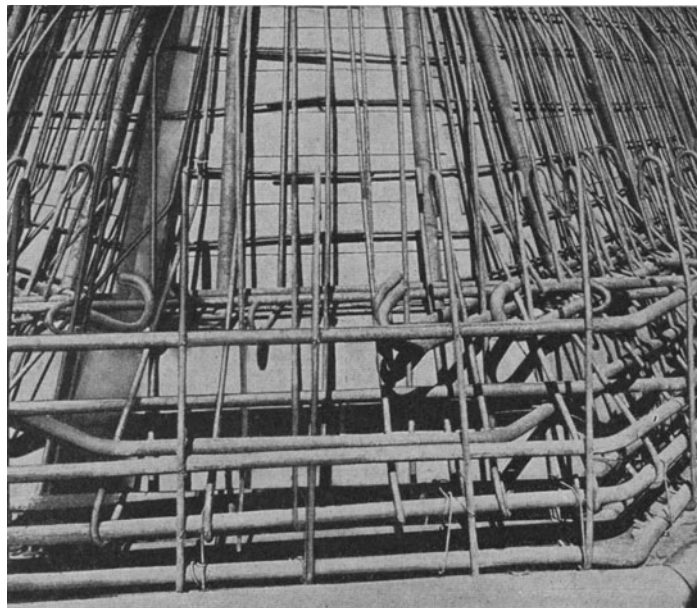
Bewehrung eines Eisenbetondruckkastens.
